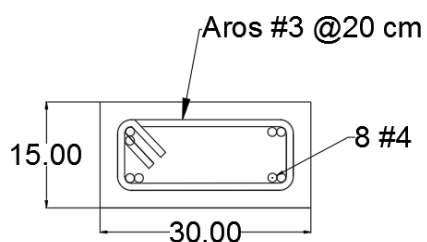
Detalle de columna en muros RA.5, RA.75 y RA1.
